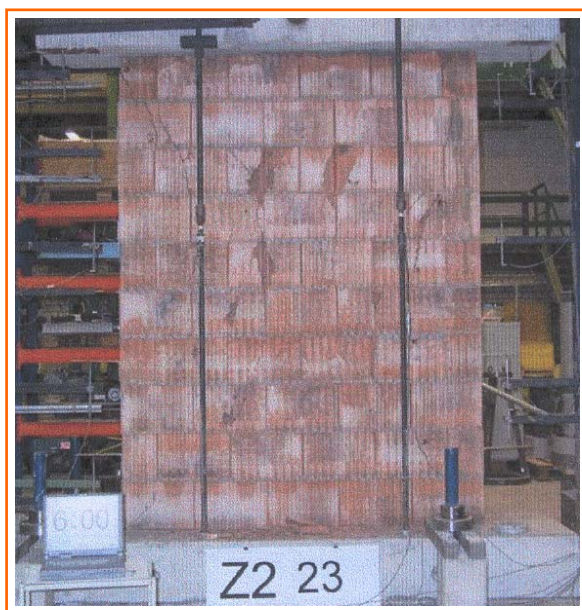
Prüfkörper mit vertikaler Randbewehrung bei 25 mm Kopfverschiebung
